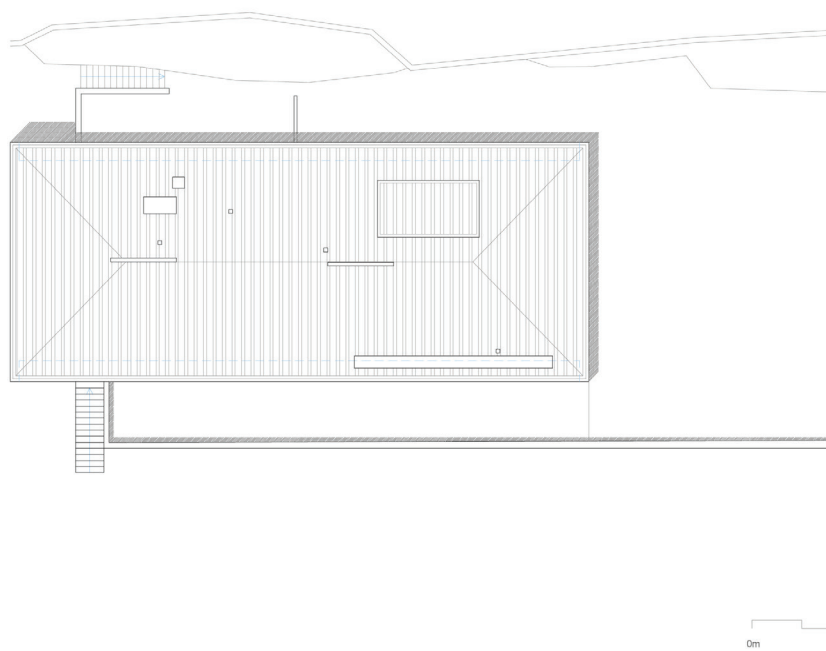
Casa no Bom Jesus: Planta de coberturas
